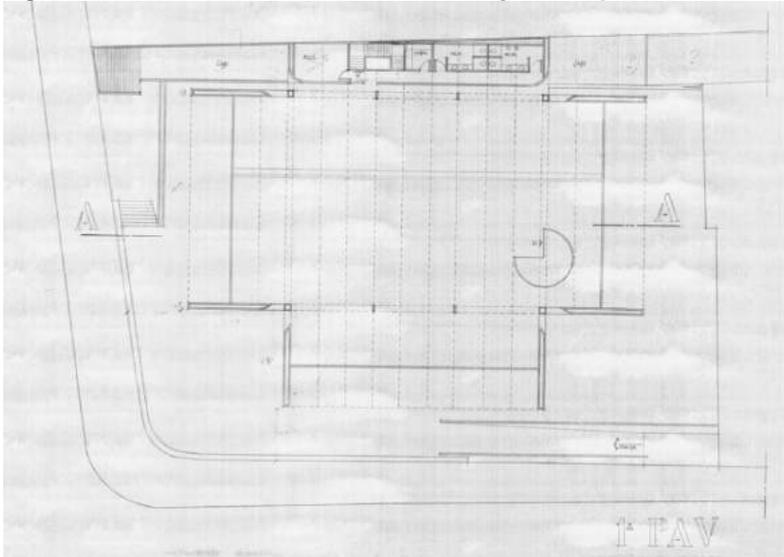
Planta Baixa 1º pav. Caixa Pç. da República. Fonte: Pontual Arquitetos.
